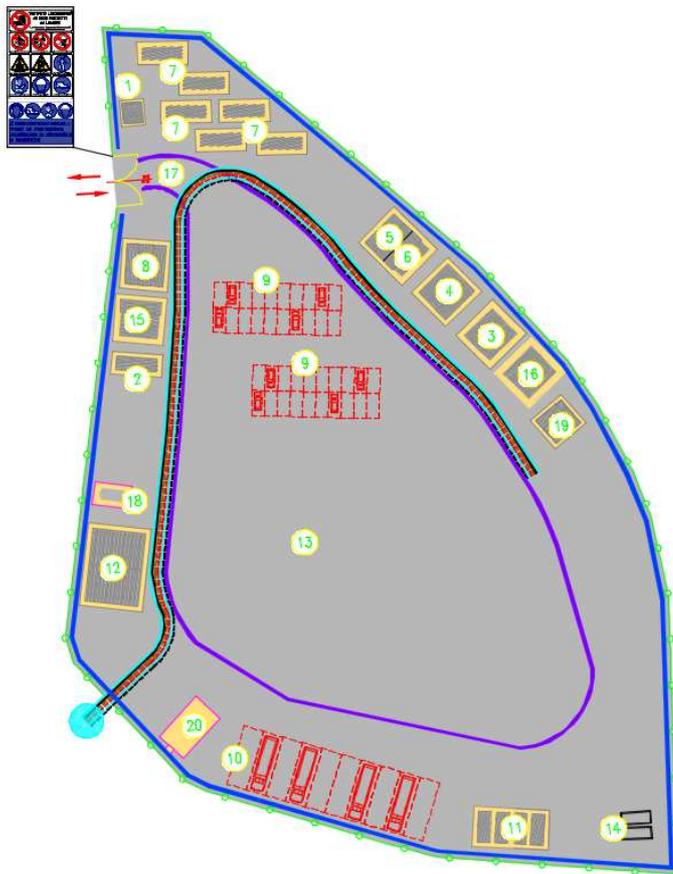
Layout del cantiere Base (Svincolo di Bonorva Sud)
